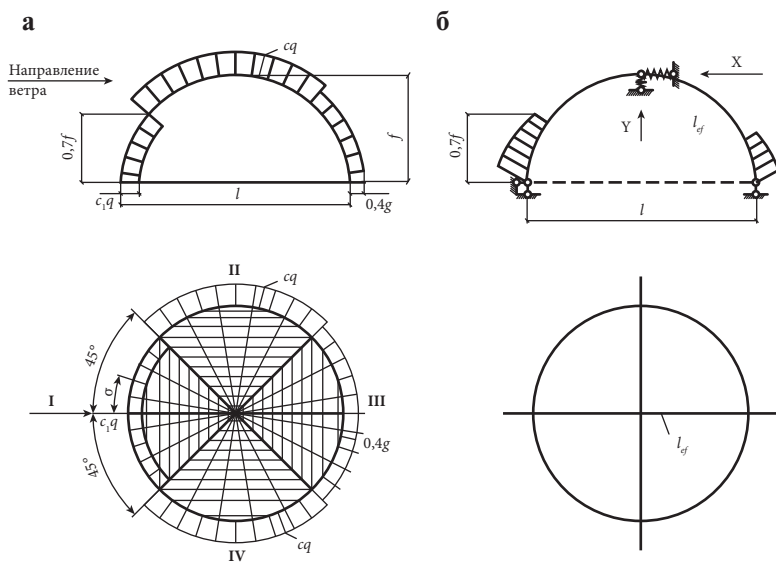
Расчетная схема ребристого купола под воздействием ветровой нагрузки: а) схема ветровой нагрузки; б) расчетная схема
